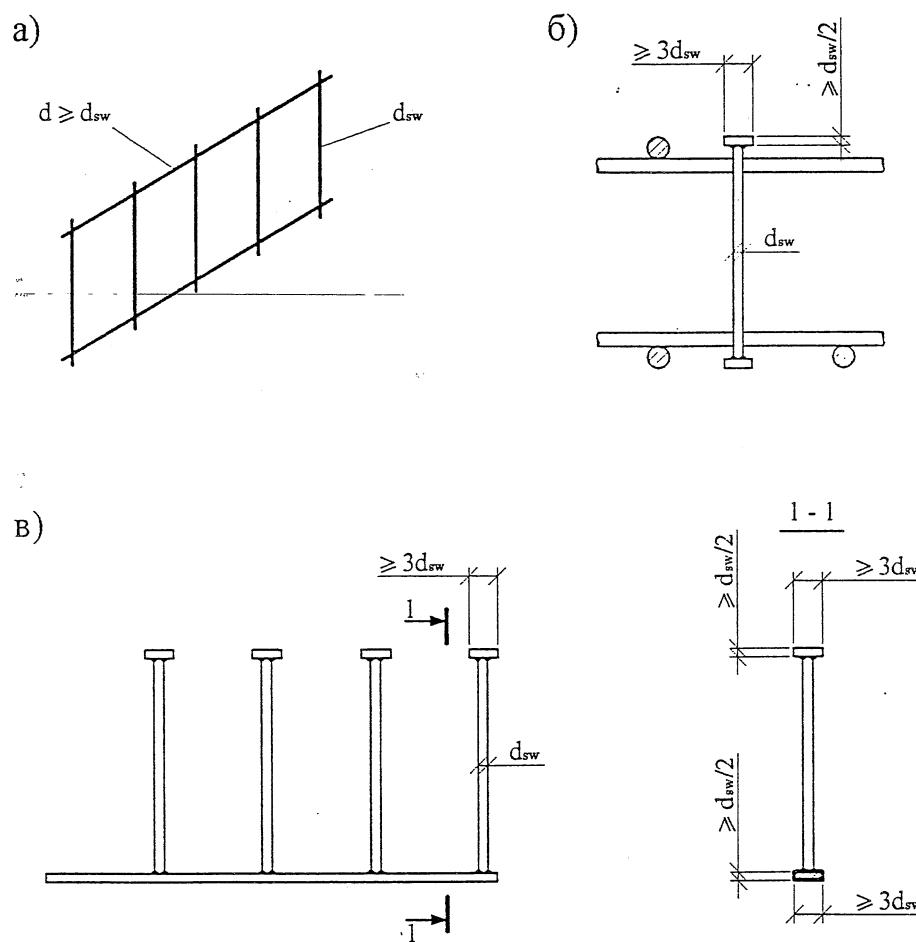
Схемы сварной поперечной арматуры
